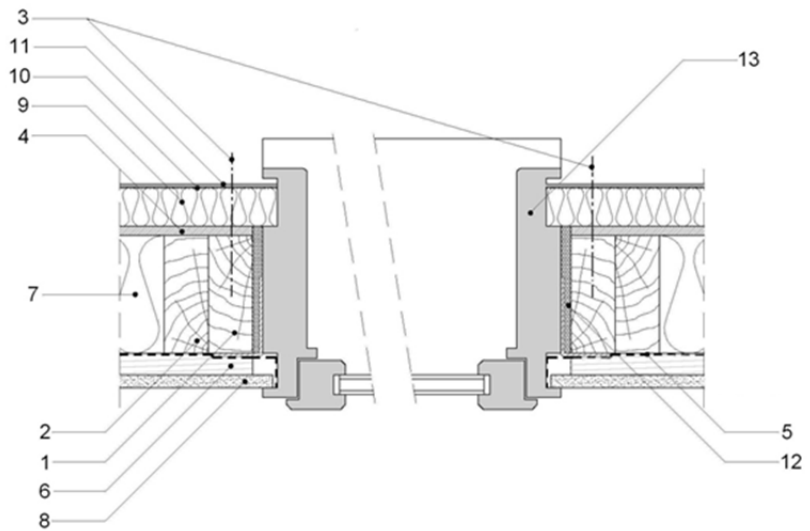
Fixations mécaniques au niveau des baies (coupe horizontale)
